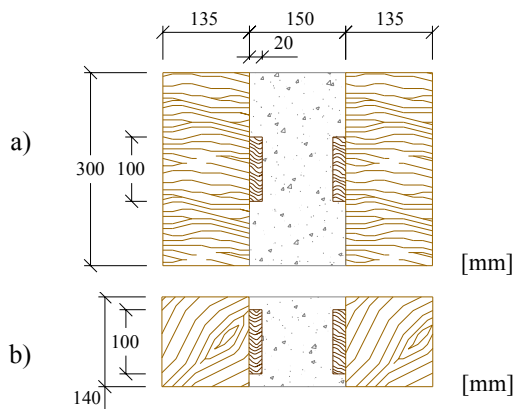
Dimensões dos elementos que compõem os provetes Pinho 100mmx100mmx20mm: a) alçado; b) planta
